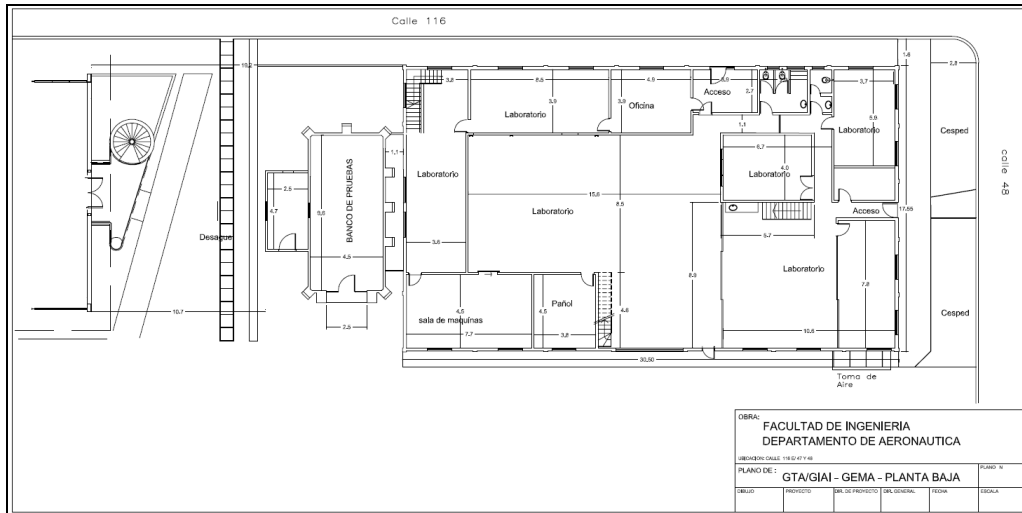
Plano de la planta baja del Edificio Laboratorios (GTA/GIAI – GEMA) y Talleres
